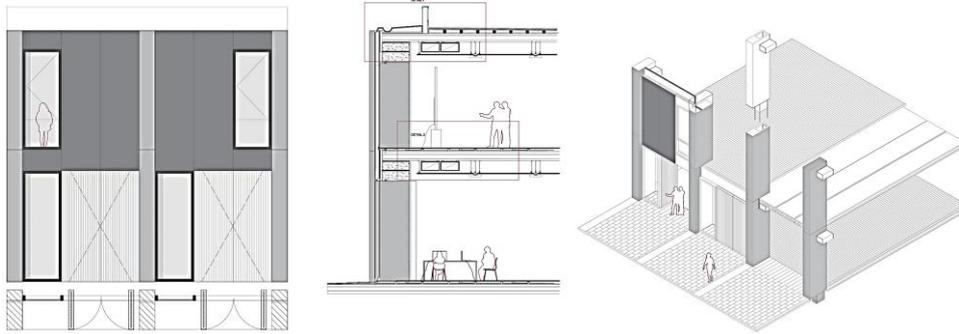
Propuesta KUWI de Nuria Dalmau (ETSAB). Detalle de fachada y sección constructiva.
